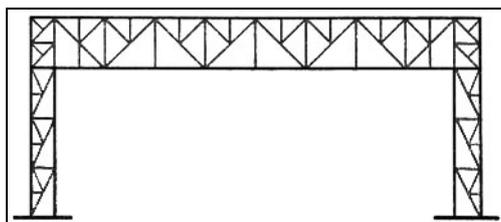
Схема решетчатой стальной рамы большого пролета
